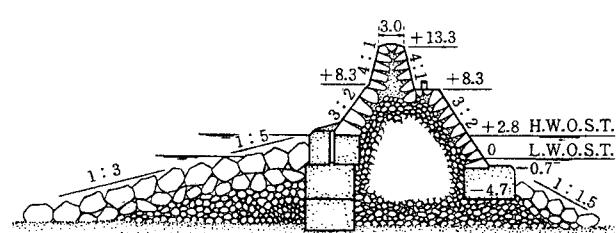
函館漁港船入場防波堤標準断面図（単位：尺）
